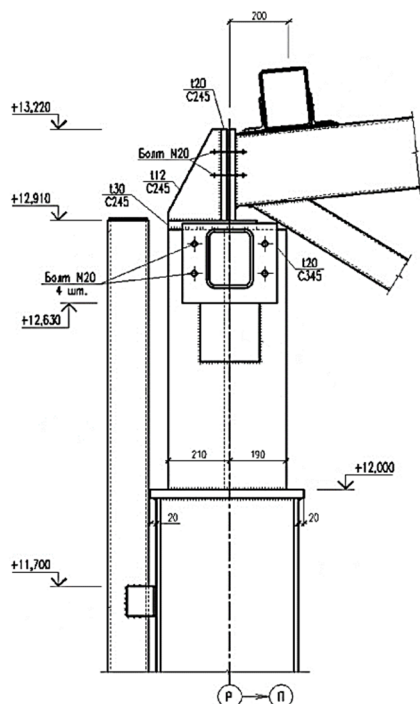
Узел сопряжения конструкций, разработанный в проекте
